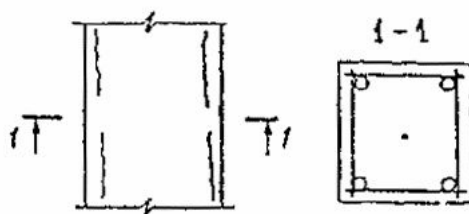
Трещины вдоль продольной арматуры в сжатых элементах
